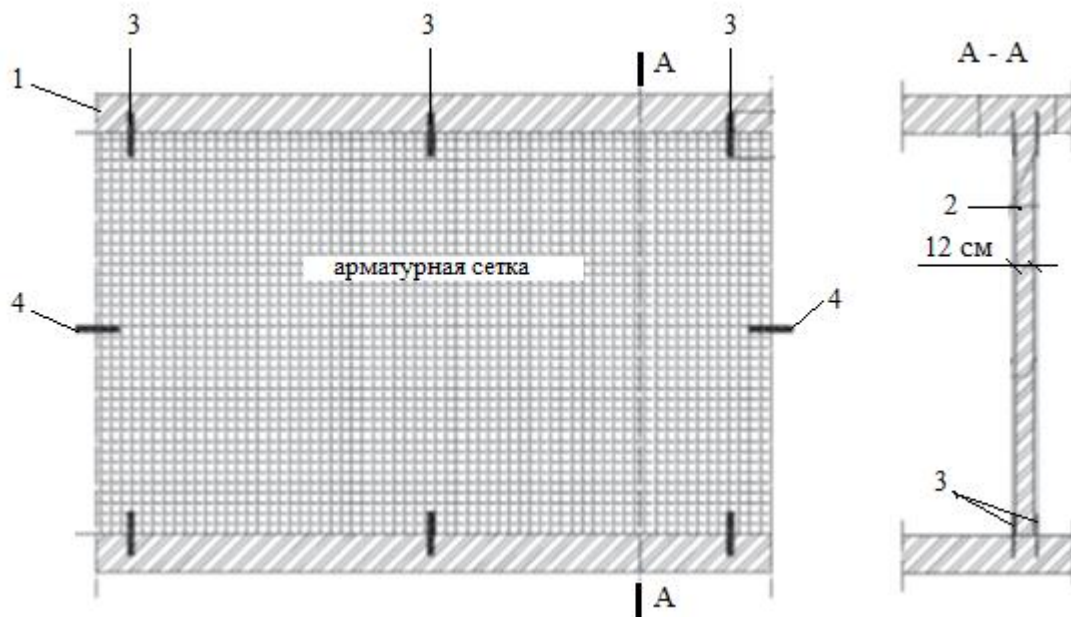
Фрагмент каменной стены армируемой сетками из композитных материалов
